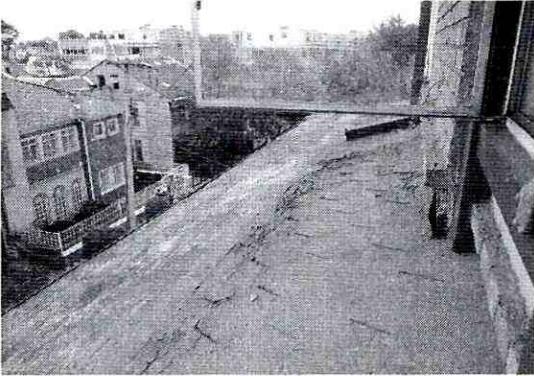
Estado actual del muro de lindero hacia la parte posterior de la edificación.
